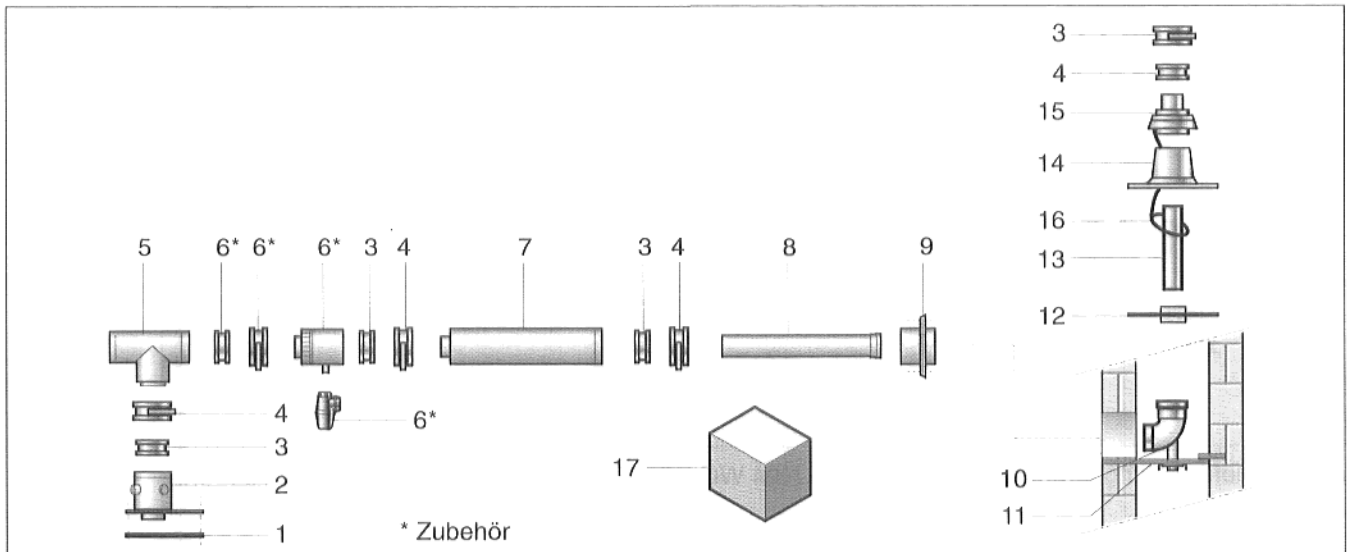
Lieferumfang Grundbausatz GA-K für GB112 W/WT und Linea, Abgasführung mit Aluminium-Rohren
